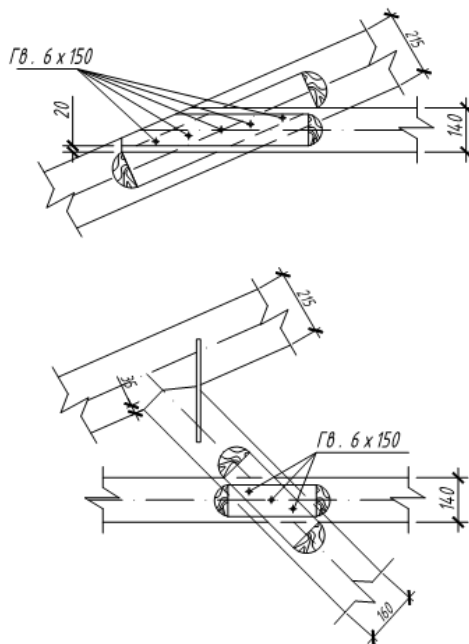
Узлы соединения ригеля со стропильной ногой и подкосом
